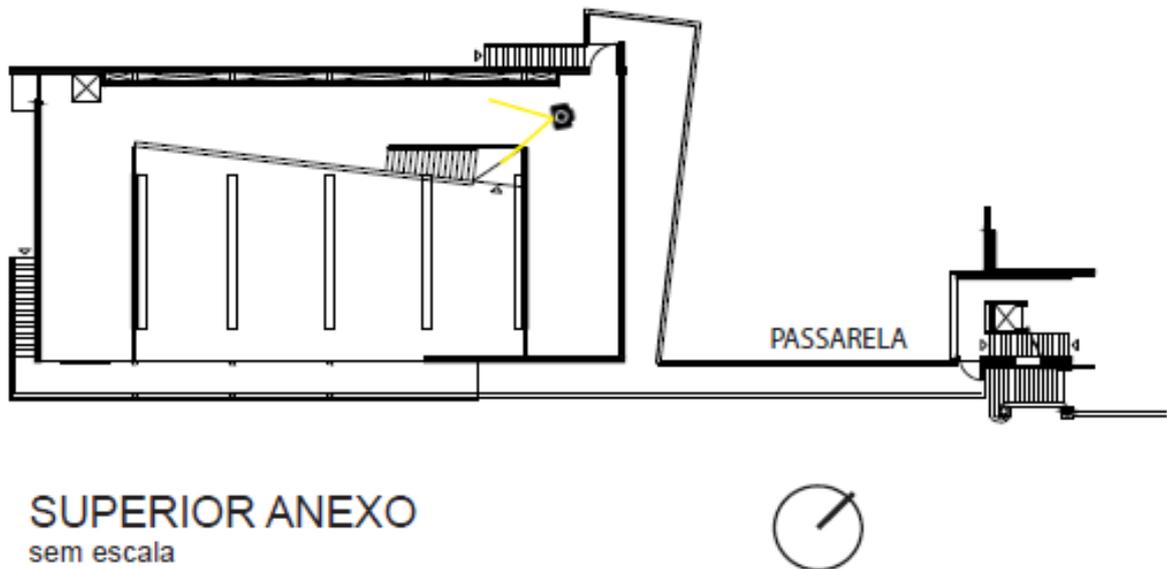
Planta do Pavimento Superior do anexo do *Palacete das Artes* (BRASIL ARQUITETURA, 2015)
